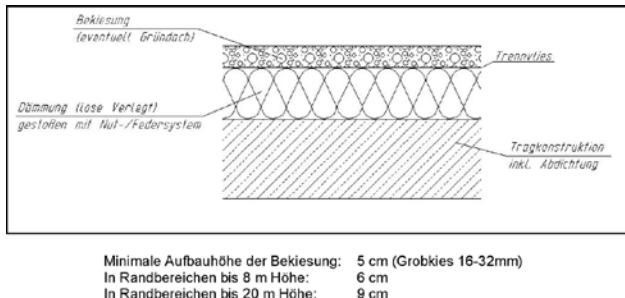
Prinzip Umkehrdachkonstruktion mit WU- Beton
